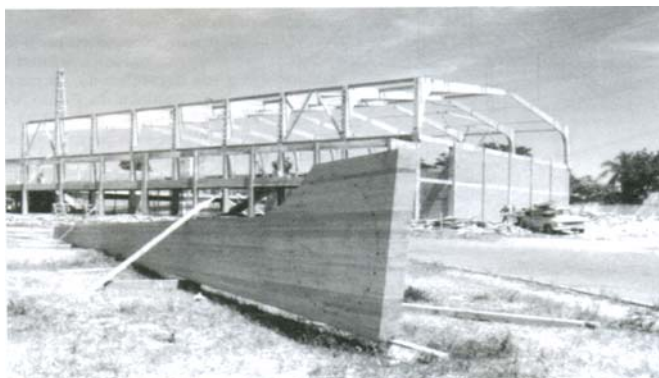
Pórtico de hastes retas em madeira laminada e colada (em primeiro plano: peça a ser montada)
